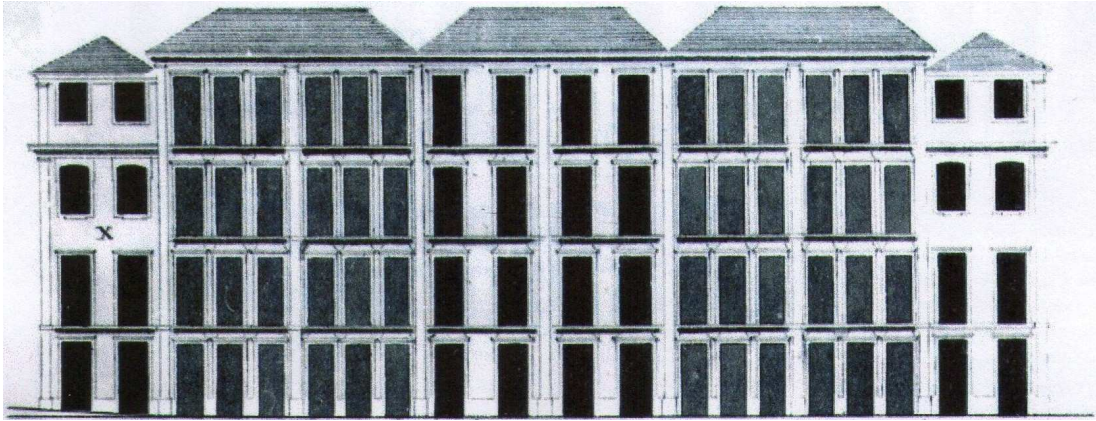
Alçado para as casas da Praça dos Ferradores - (Primeira metade de planta geral do lado do Norte) (Berrance, 1993, p. 56).
